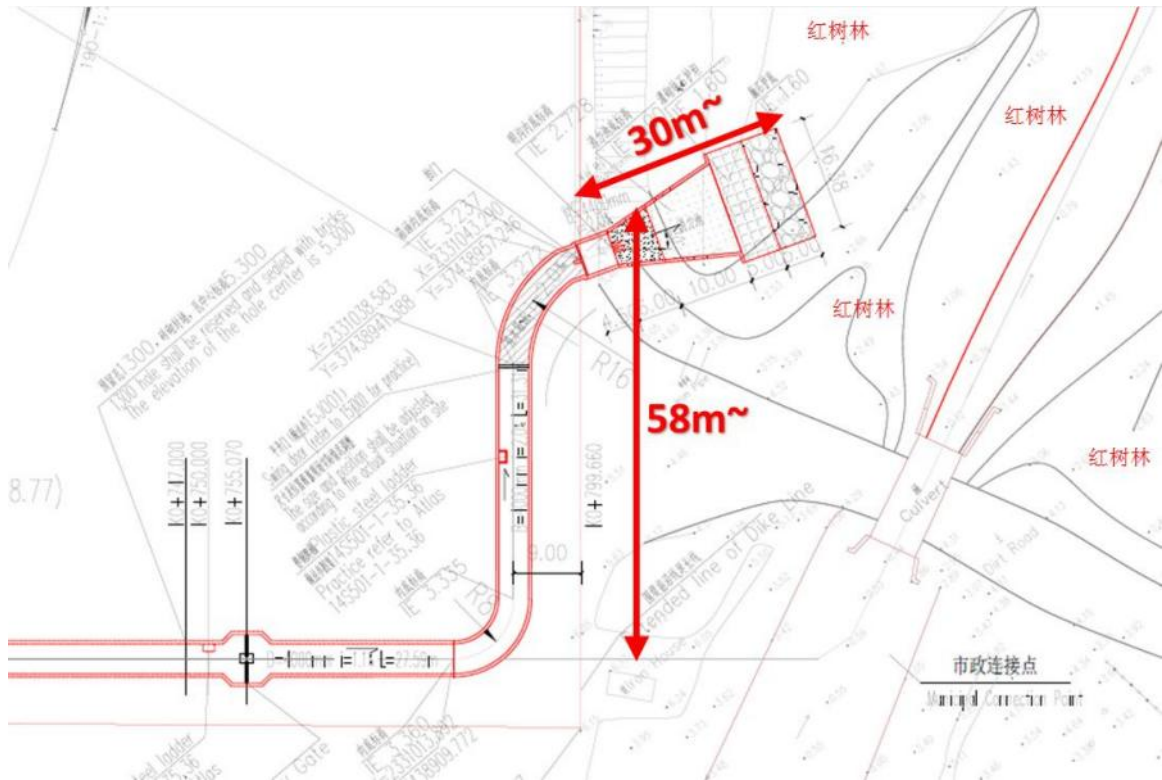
方案 B（推荐方案）东侧雨排 1#平面布置图
